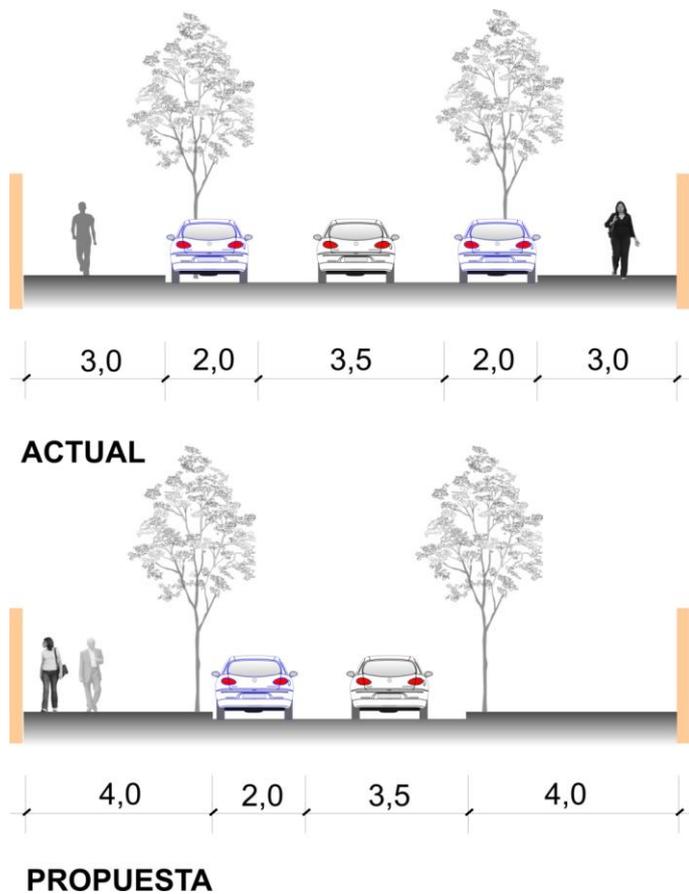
Propuesta de sección prevista en la calle Calatrava. Fuente: DOYMO.
